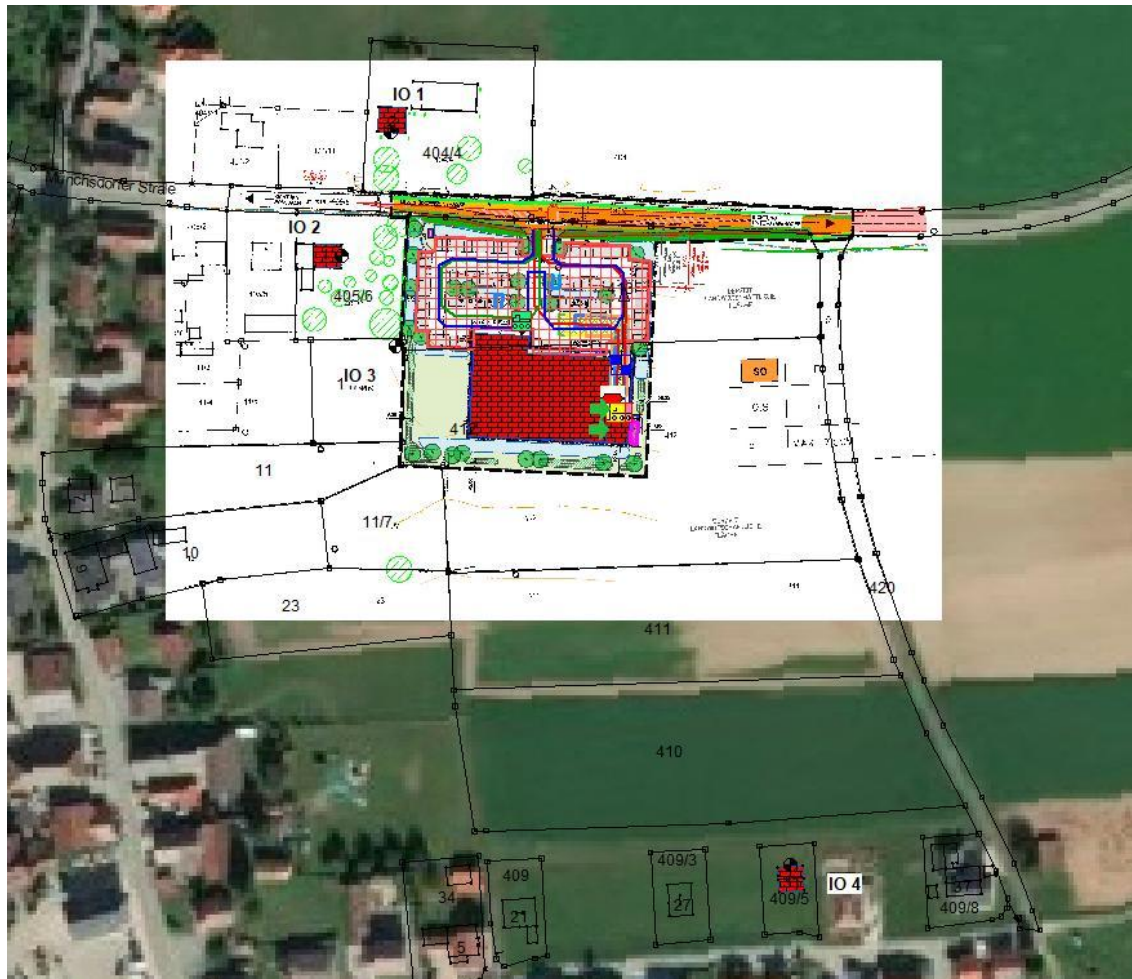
Lageplan mit Kennzeichnung der Immissionsorte IO 1 – IO 4
